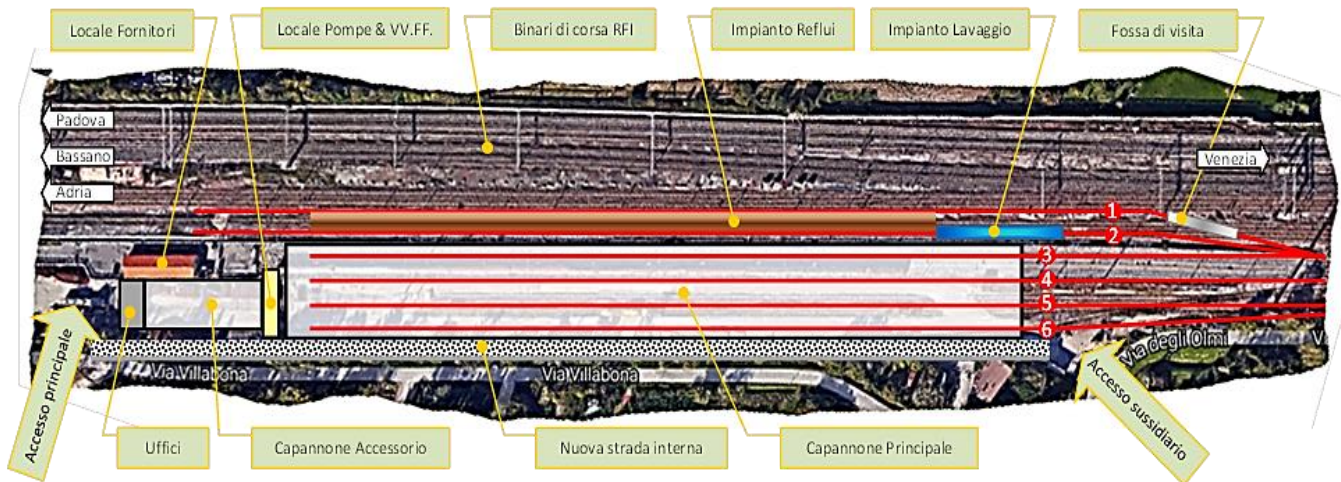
Centro di Manutenzione di Venezia Mestre - Planimetria schematica
